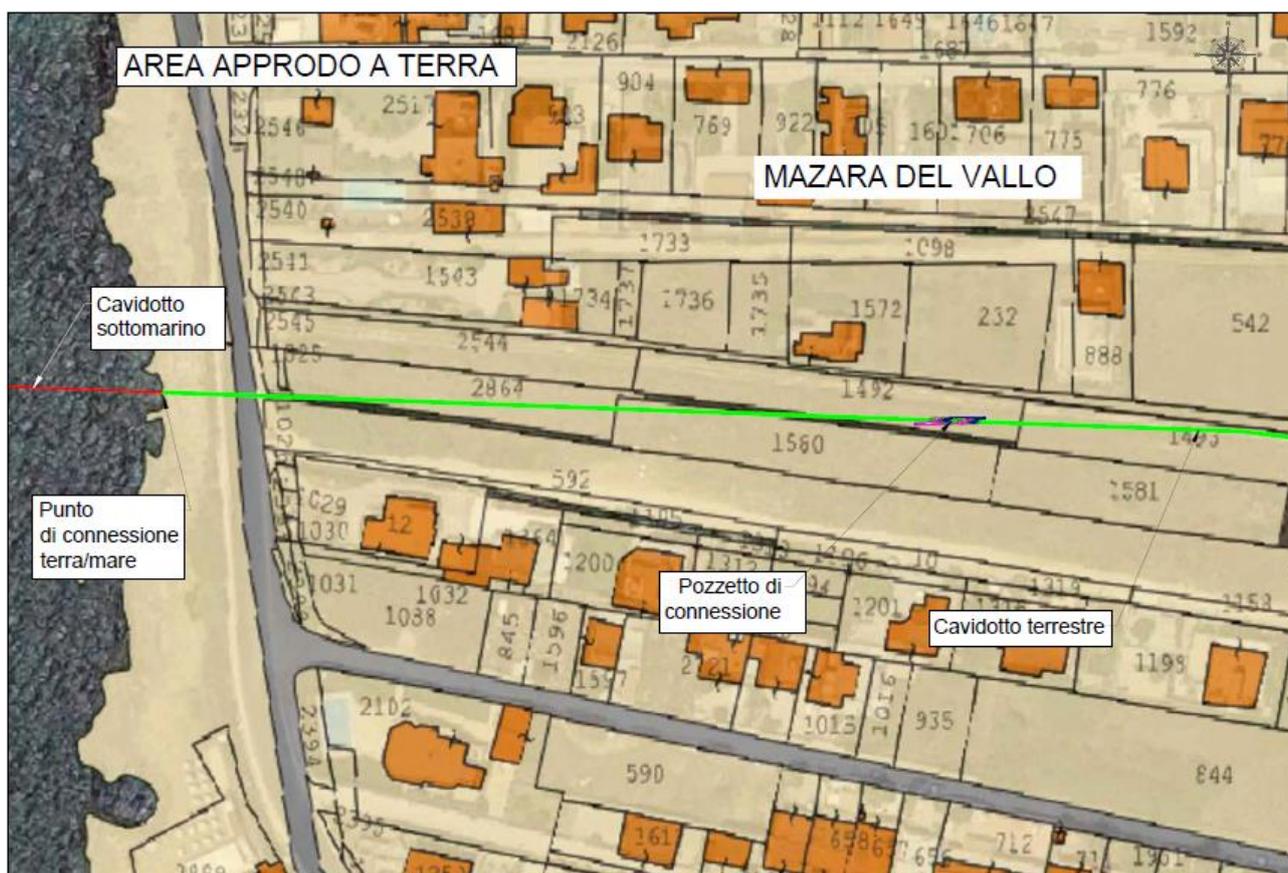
Pozzetto di giunzione allo sbarco (Transition Joint Bay – TJB)
